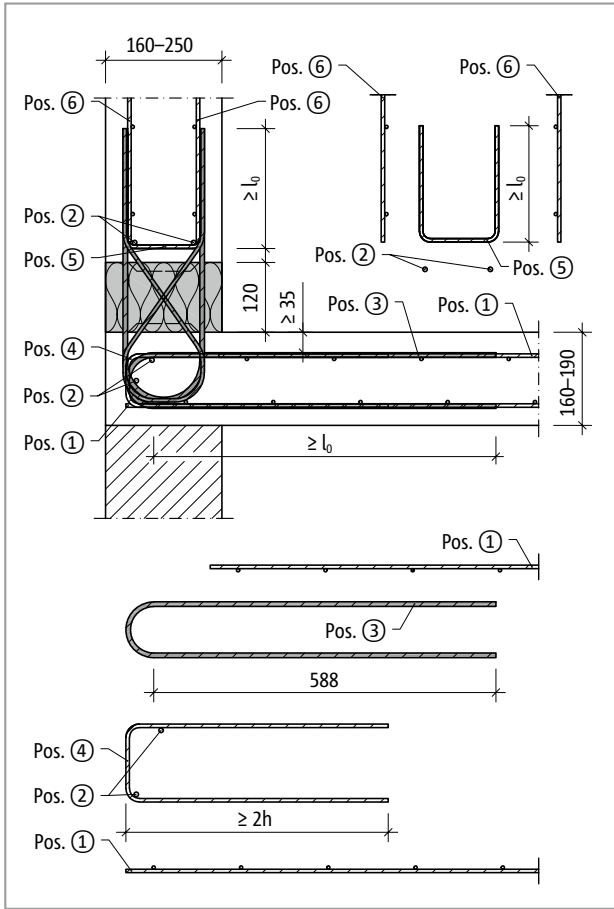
Schöck Isokorb® XT Typ A: Bauseitige Bewehrung innenliegend
